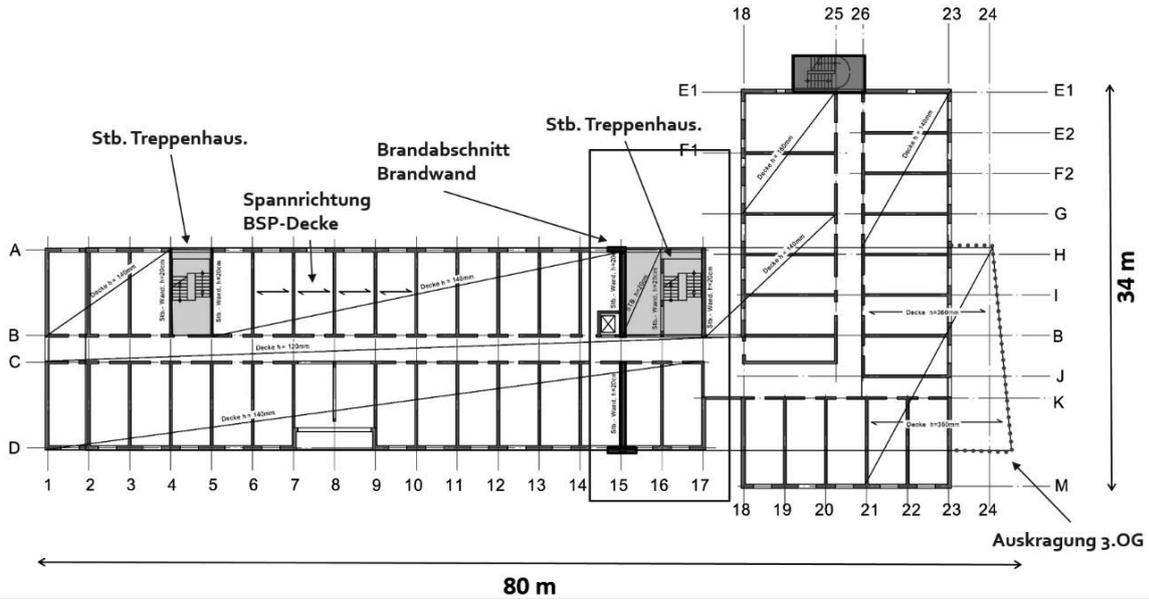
Grundriss Alfter [Knevels & Röttgen]
